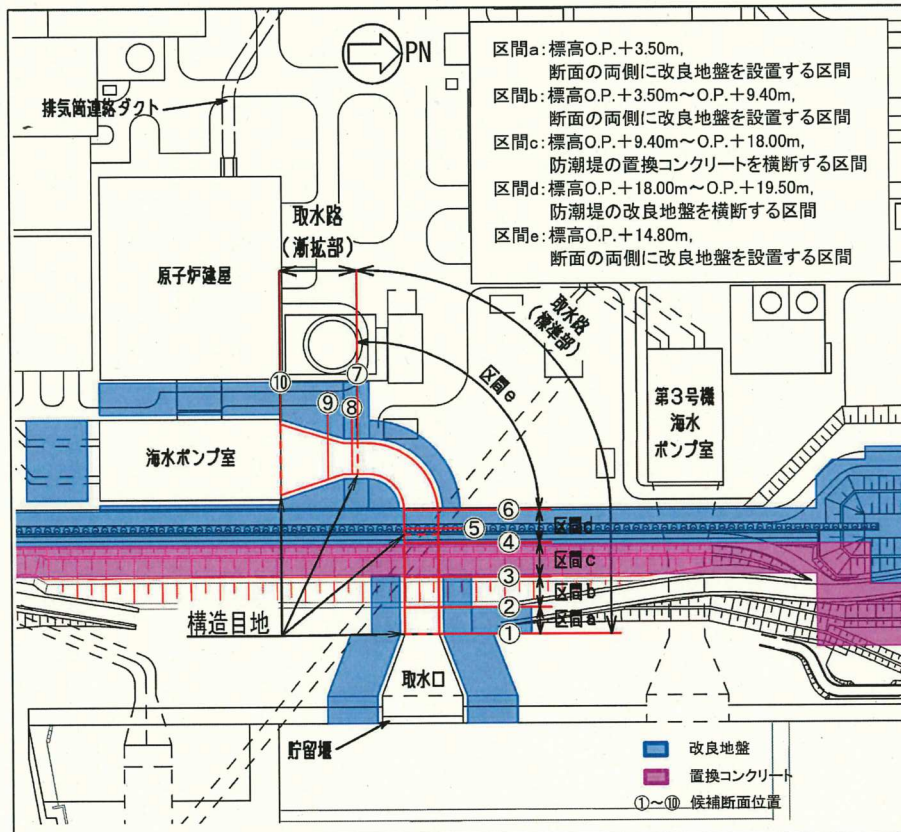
取水路平面図 (区間及び候補断面位置)
